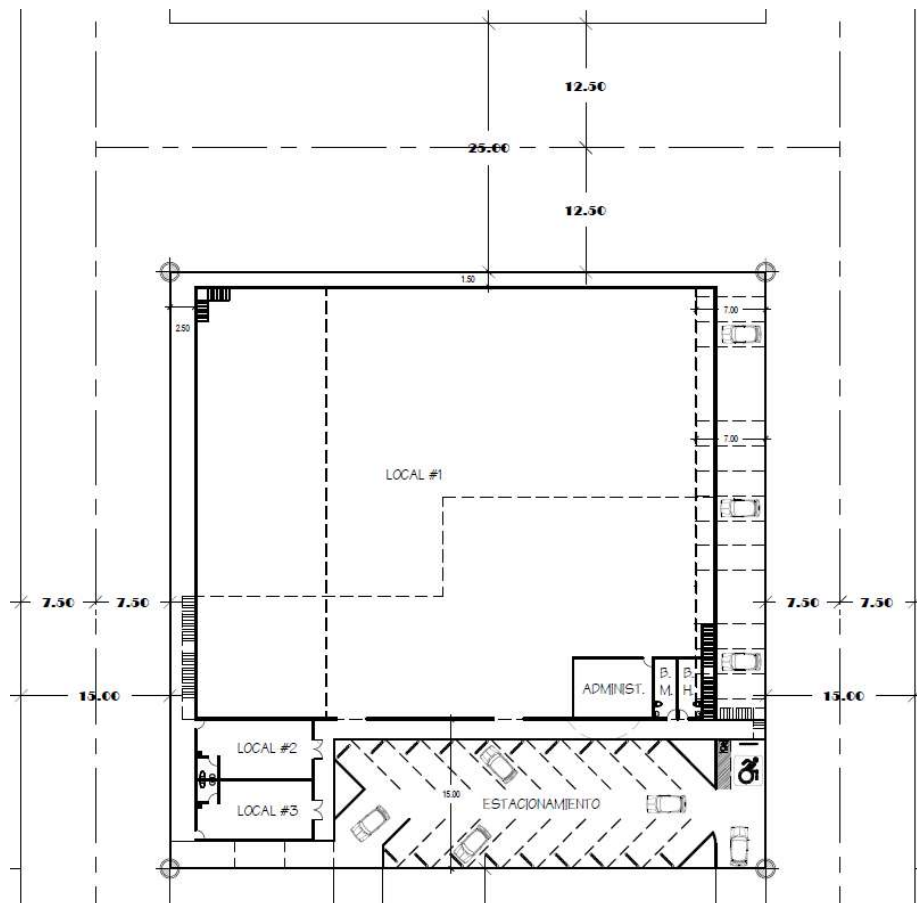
Detalle típico de las Distintas Infraestructuras
